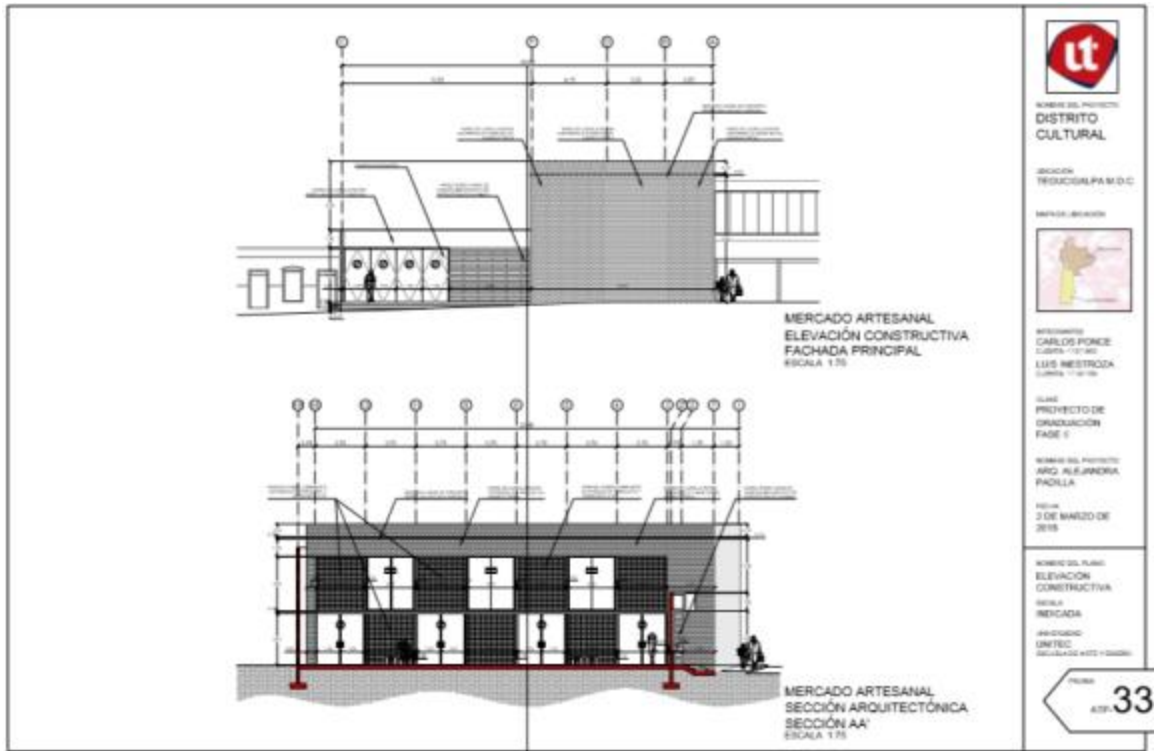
Fachada y Sección Constructiva Mercado Artesanal
